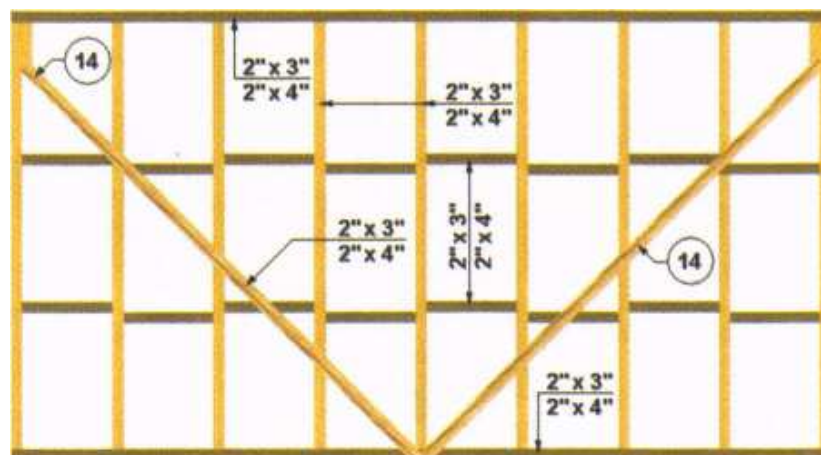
Entramado vertical arriostrado por medio de diagonales estructurales, de igual escuadría que las piezas principales
